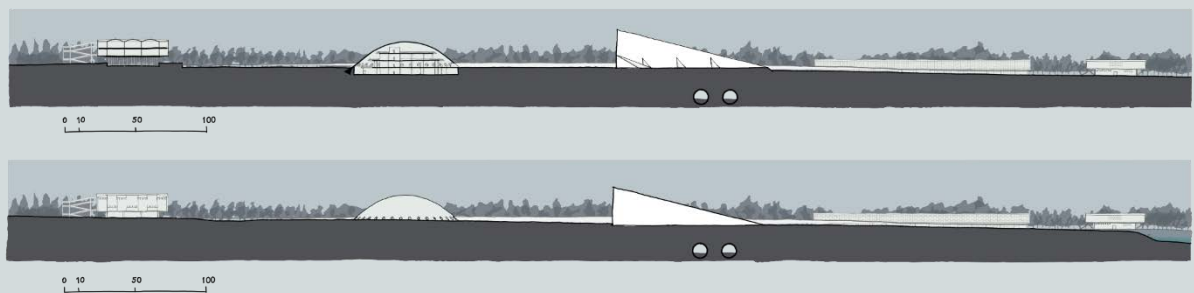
Implantação – 2000 – Versão 02 – desenho nosso.
